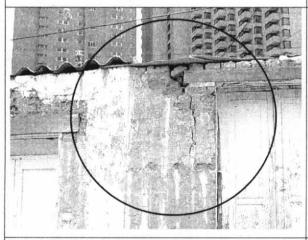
Detalle de agrietamiento y dislocación de piezas de mampostería del muro fachada, visto por el interior del inmueble.
